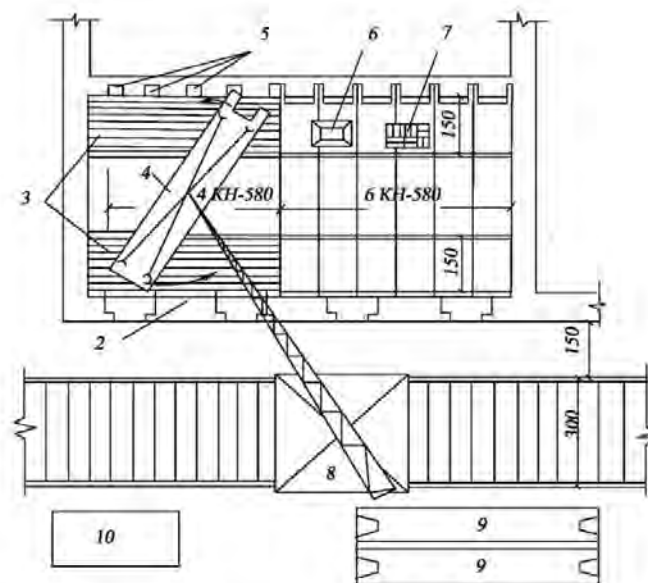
Схема организации работ по монтажу участка перекрытия из железобетонных пустотных настилов с выпускными консолями: 1 – уложенные настилы; 2 – пробитая борозда в наружной стене; 3 – подмости; 4 – монтируемый настил; 5 – пробитые гнезда во внутренней стене; 6 – ящик с раствором; 7 – кирпич; 8 – башенный кран; 9 – железобетонные настилы; 10 – компрессорная станция.
